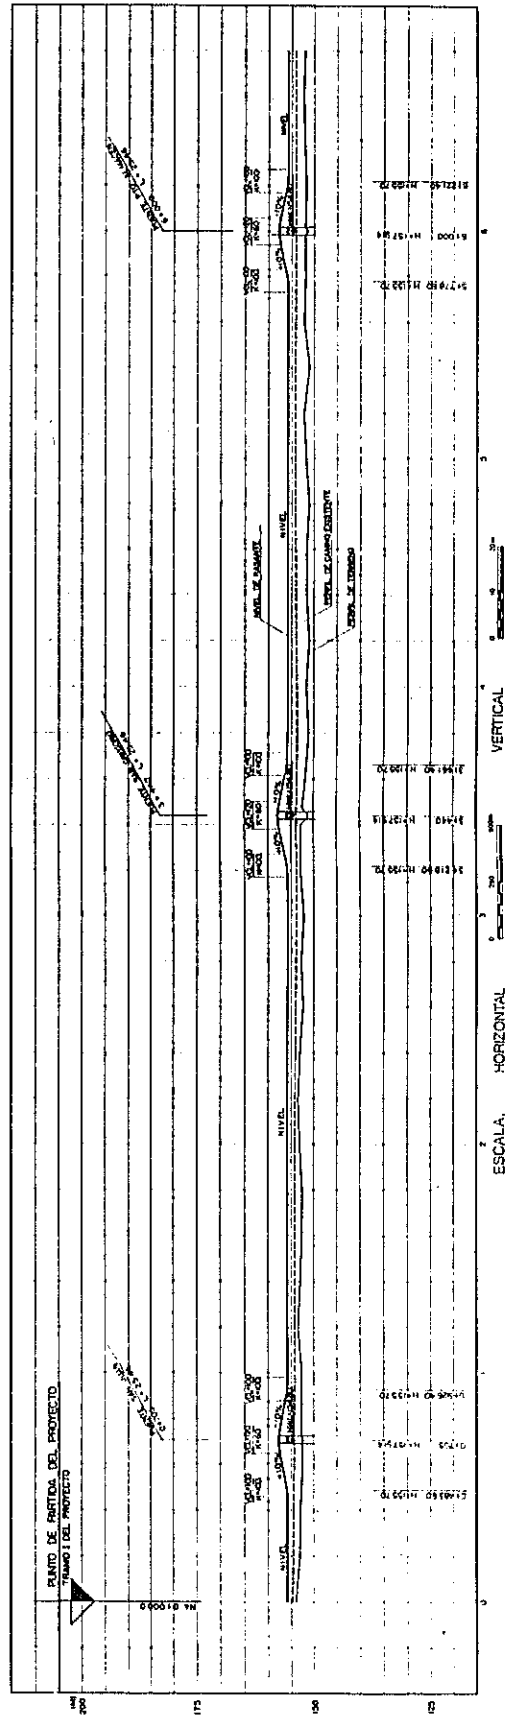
Plano de Ubicacion de Los Trabajos de Fase II
